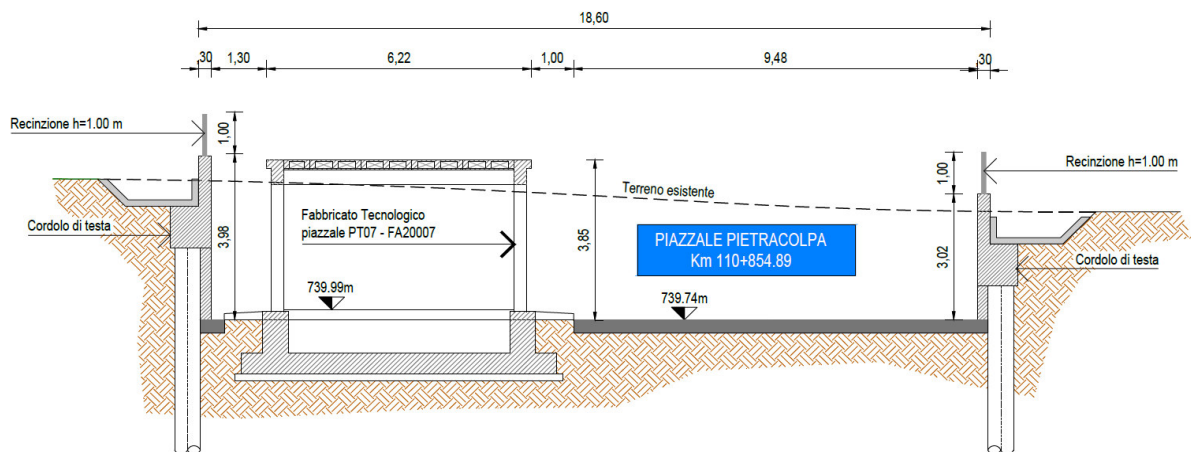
Sezione piazzale Galleria Pietracolpa Imbocco Nord
